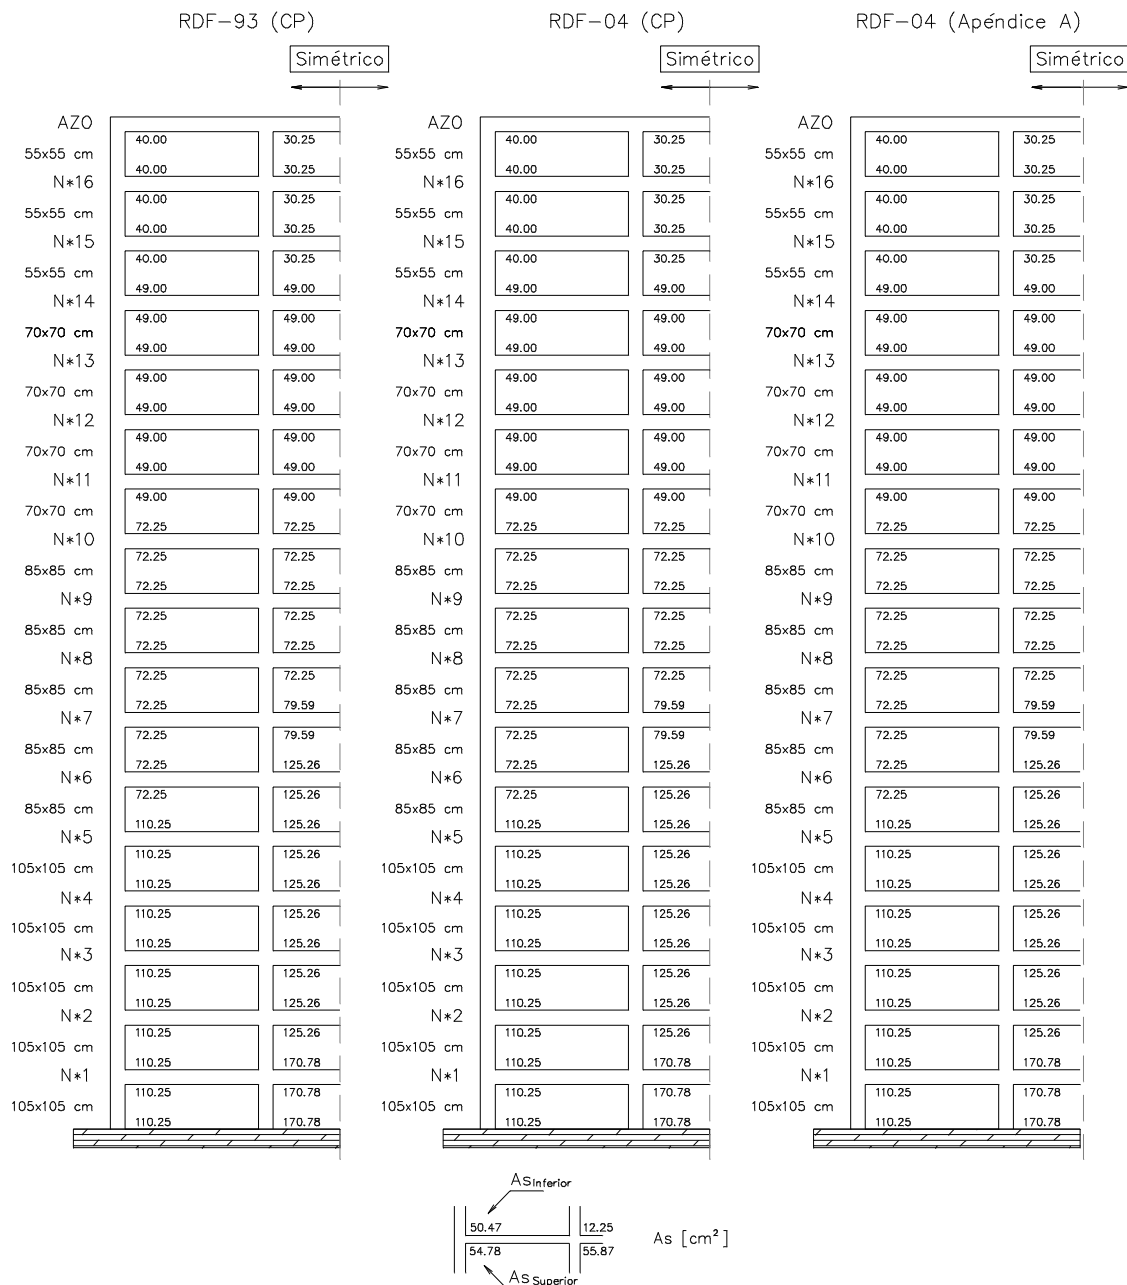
Comparación de áreas de acero de refuerzo longitudinal de las columnas del eje 2 de las estructuras diseñadas en zona II (RDF-93 y RDF-04)
